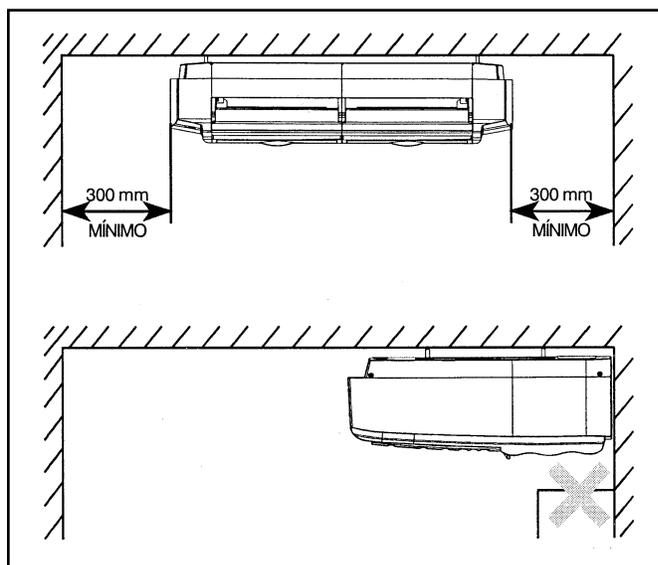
MONTAGEM TETO - UNDER CEILING
